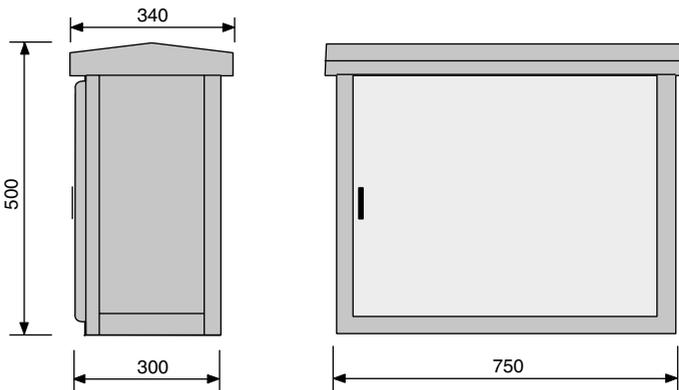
dimensiones de las CGP y seccionamiento tipo PL-57T.
